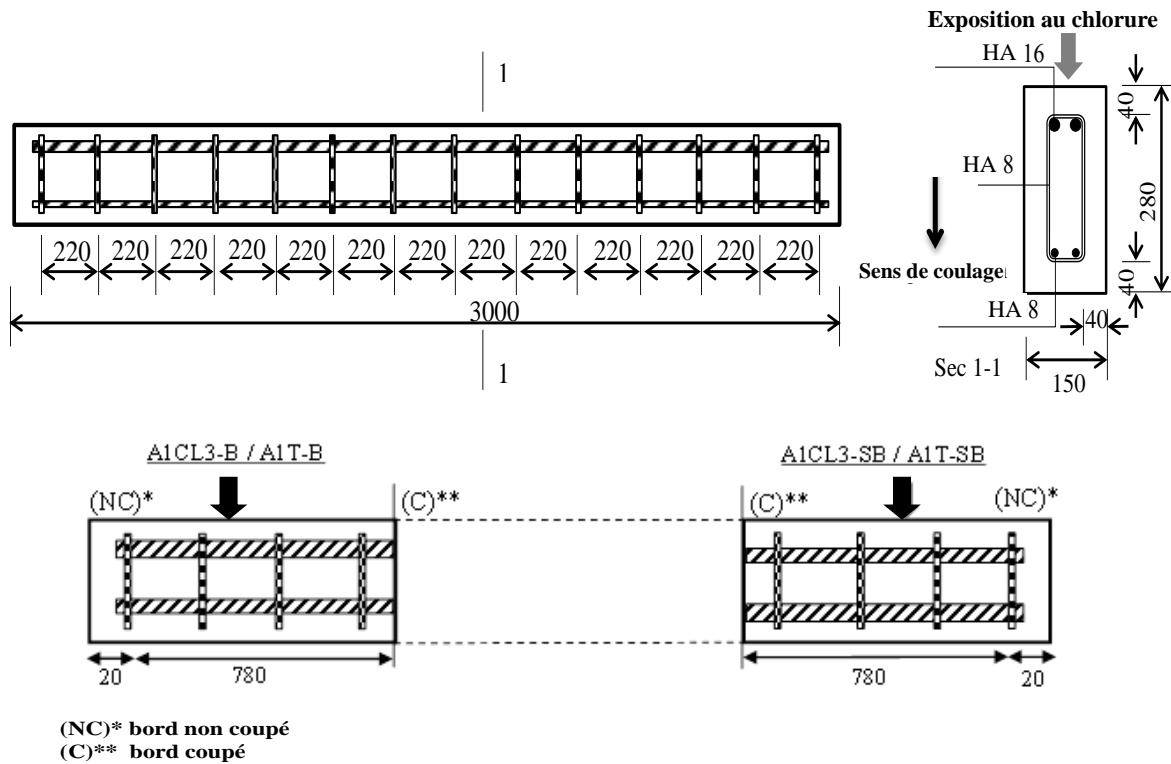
Plan de ferrailage des poutres longues (toutes les dimensions en mm).
